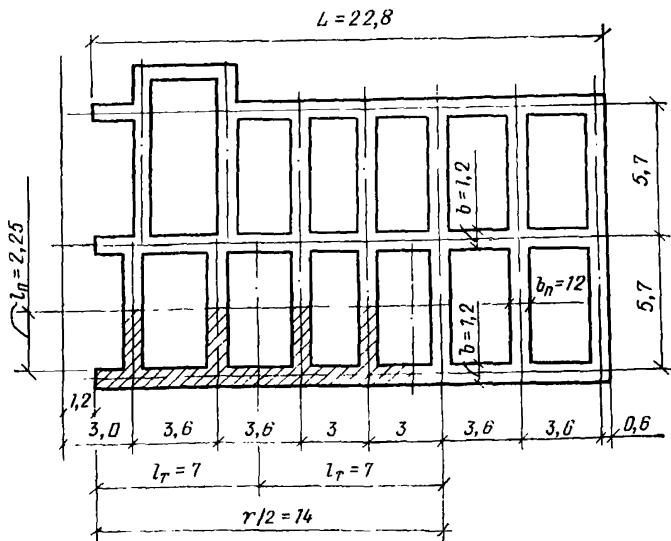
Схема плана фундаментов к примеру расчета 4.1
